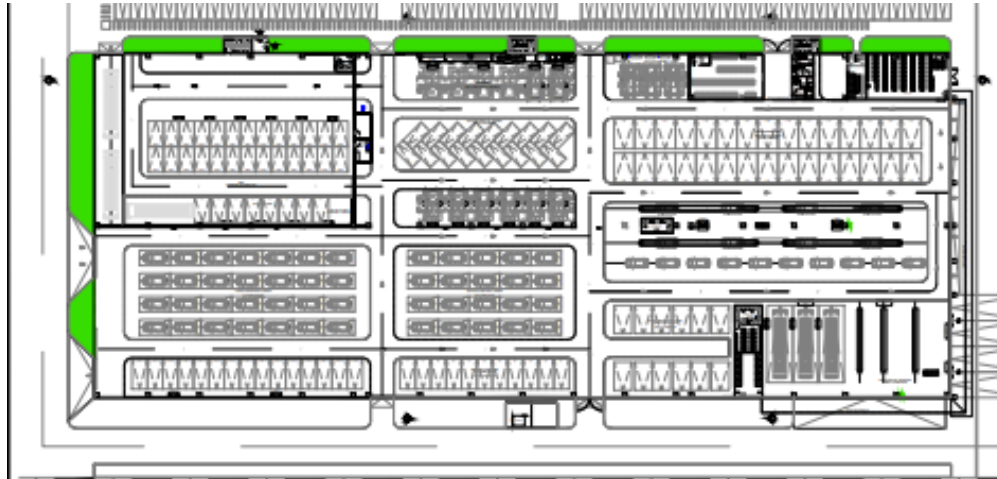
"Layout actual Galpón Preentrega Lonquén". Fuente Propia.
